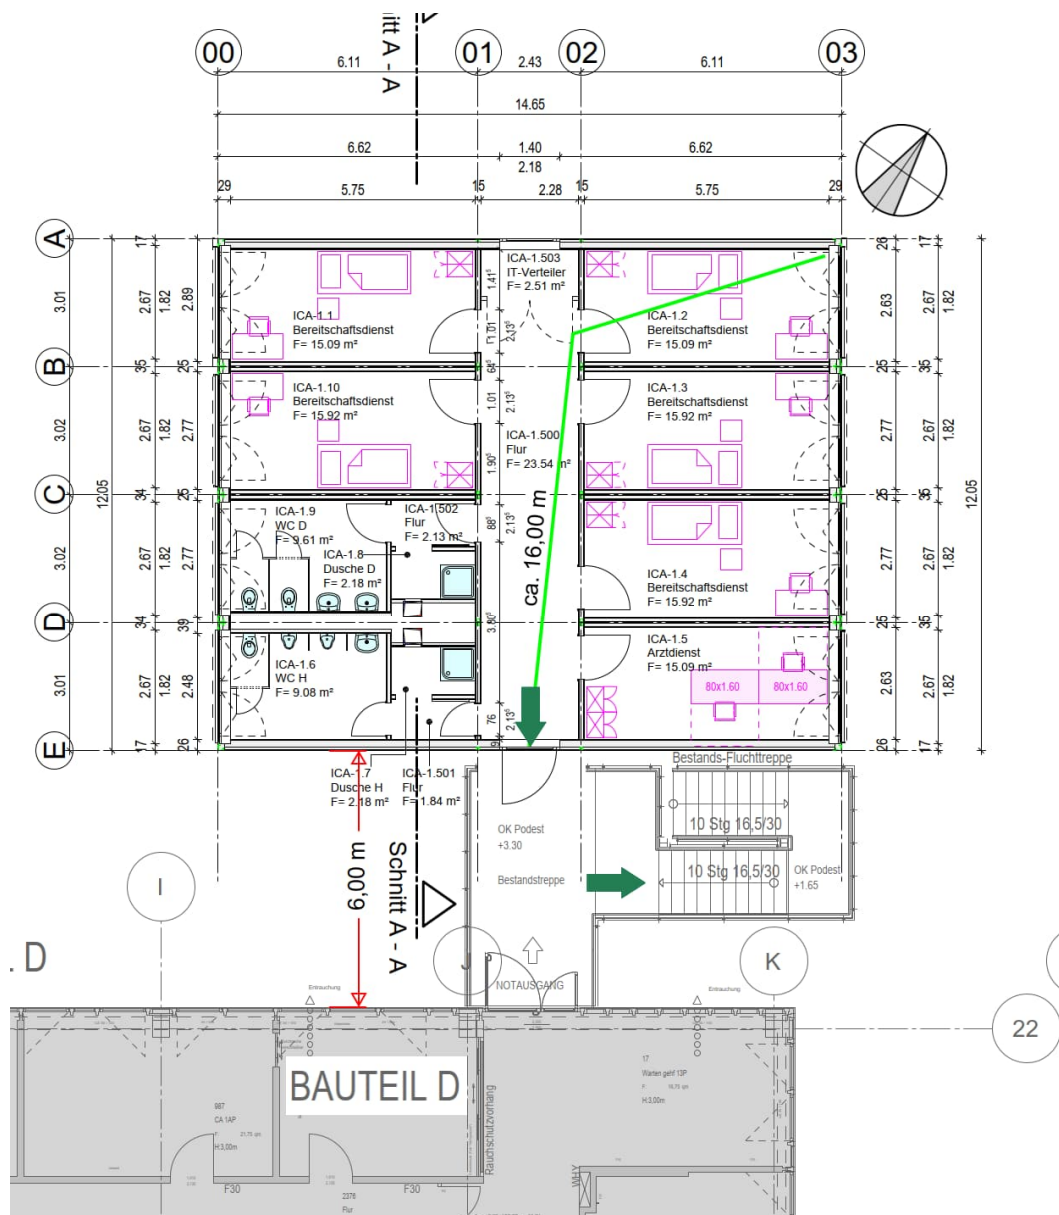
Grundriss Obergeschoss Interims-Container-Anlage
